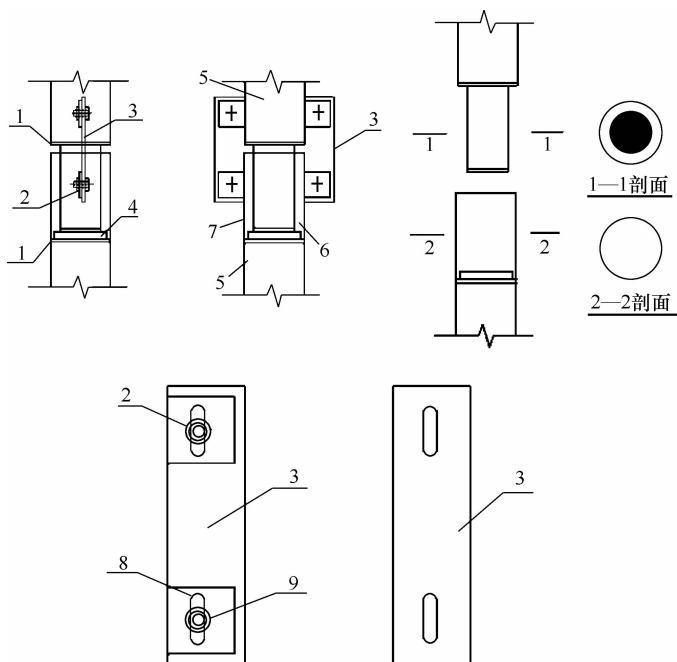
隧道薄壁钢管混凝土初期支护承插式接口构造示意
